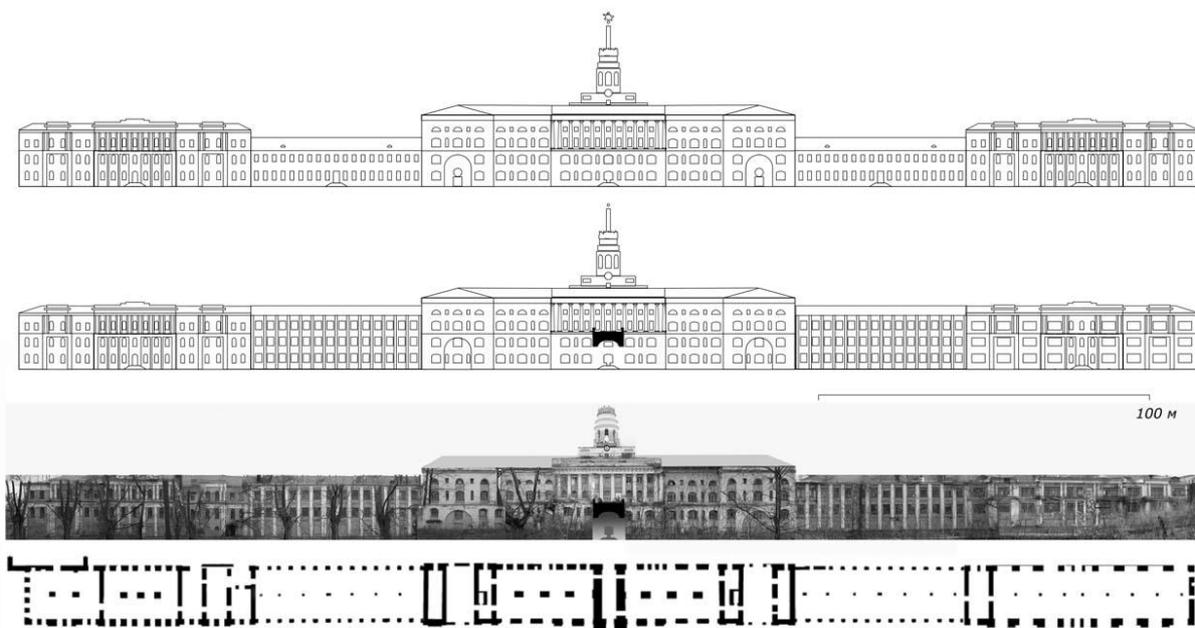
Современное состояние ГК. Вверху – Схема №2; в центре – Схема №3; внизу – фотоколлаж 2021 и план 1-го этажа ГК
